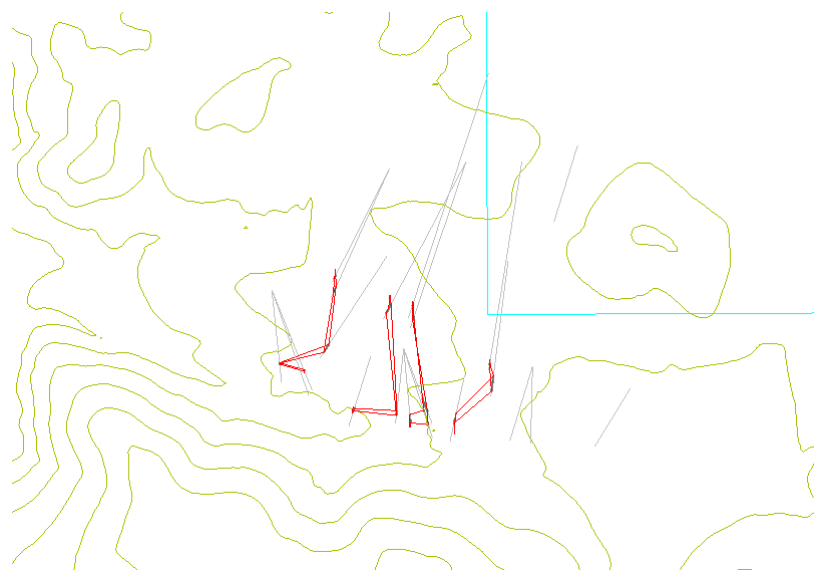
Vista en planta de las secciones de La Romanera - Fuente: Recursos propios.
